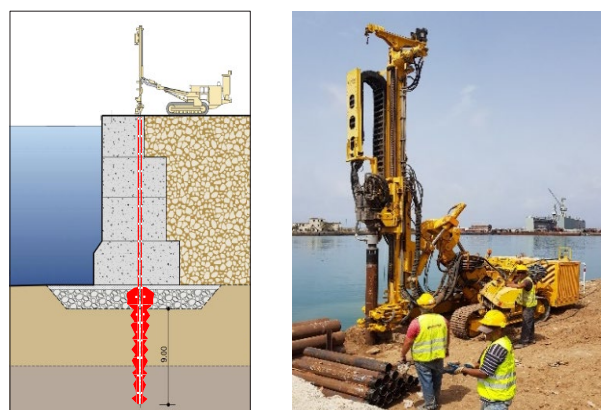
Execução das microestacas de reforço da fundação dos muro cais existentes
